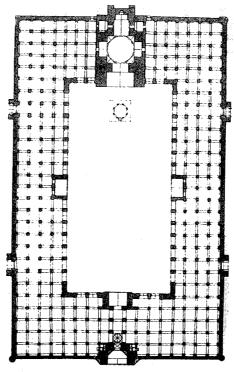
مسقط أفقي لمسجد بيبي خانم في سمرقند . (عن ليزا جلومبك ودونالد ولبر) .
